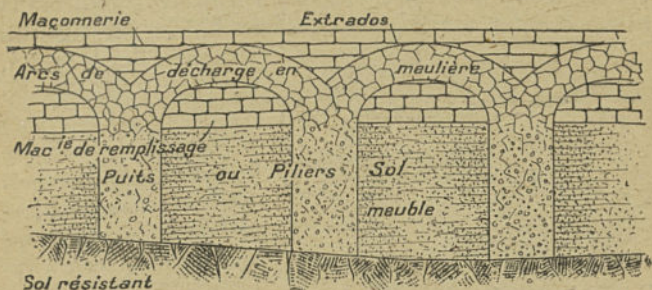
Piliers et arcs de fondations en terrain meuble.
